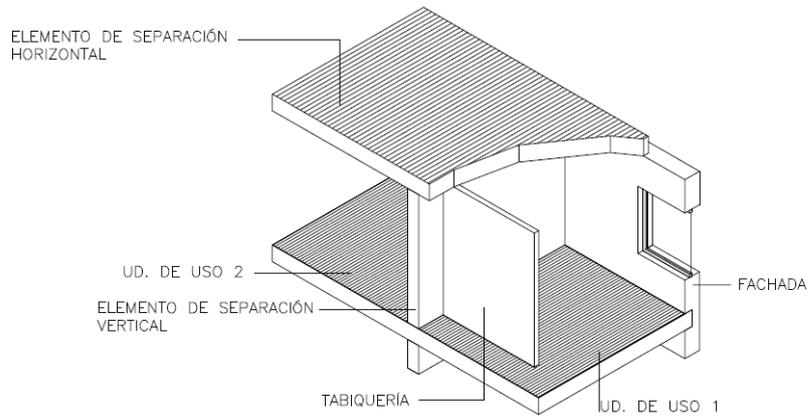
Elementos constructivos de la opción simplificada (Fuente: [15])
